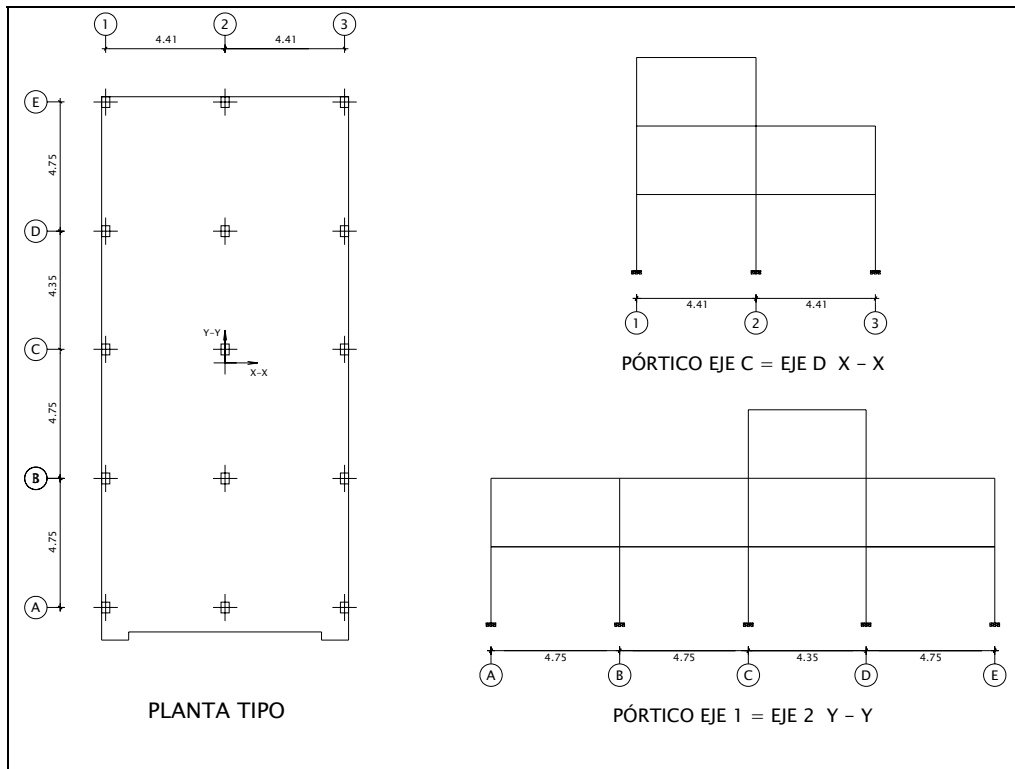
Configuración en planta y elevación de estructura analizada.
